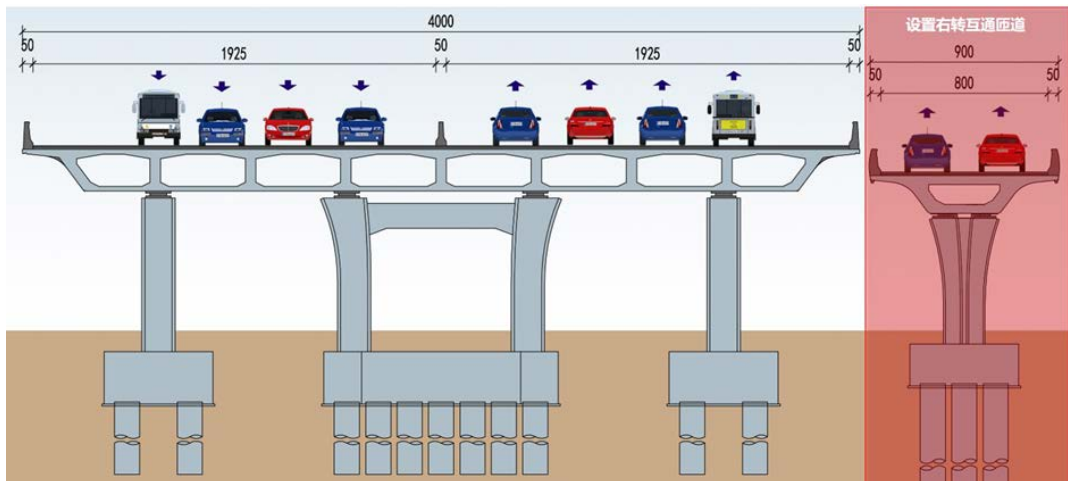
五星枢纽增设南转东匝道（青年路段）标准横断面图
